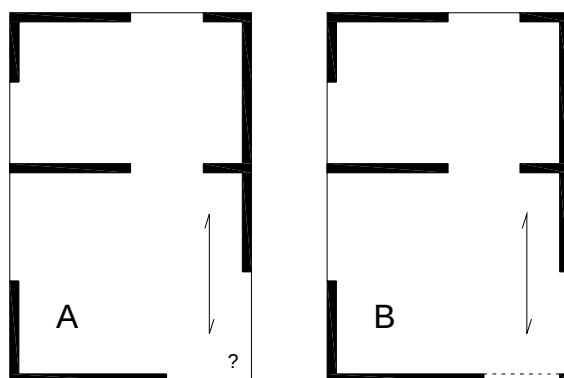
Disposizione in pianta dei solai. Nel caso A il solaio non trova appoggio nel punto "?";
